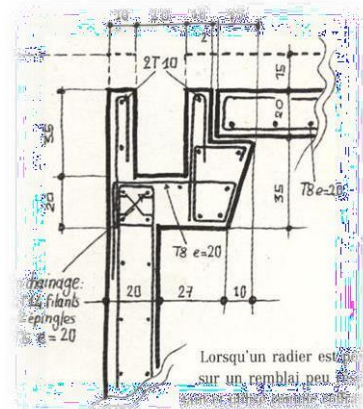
Détail du ferrailage de l'appui d'une plage sur une chéneau de piscine à débordement
